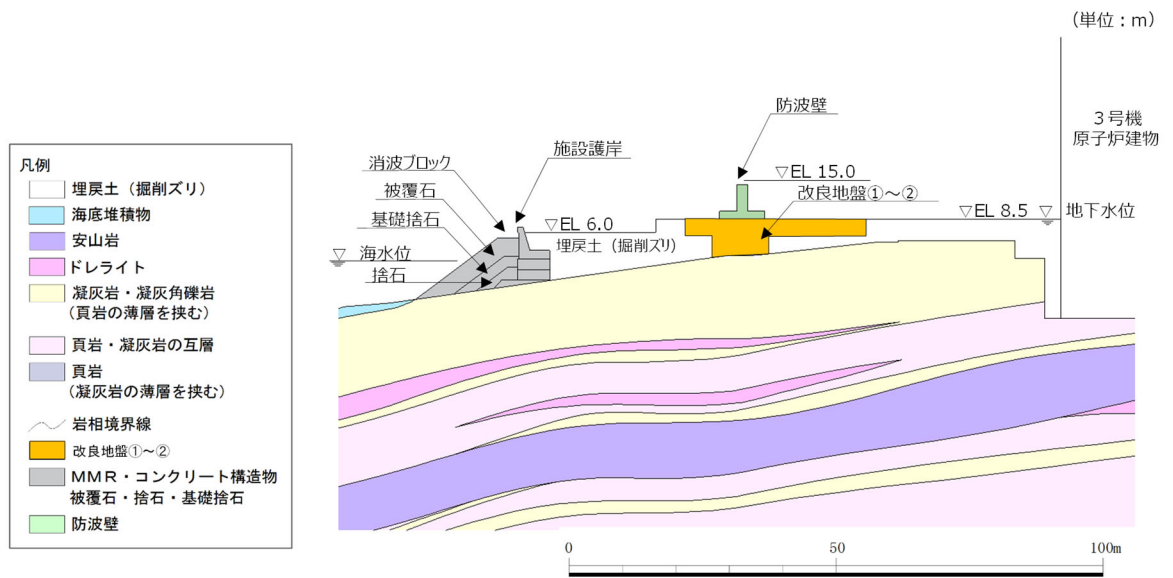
防波壁（逆 T 擁壁）の横断面図（③-③断面）
